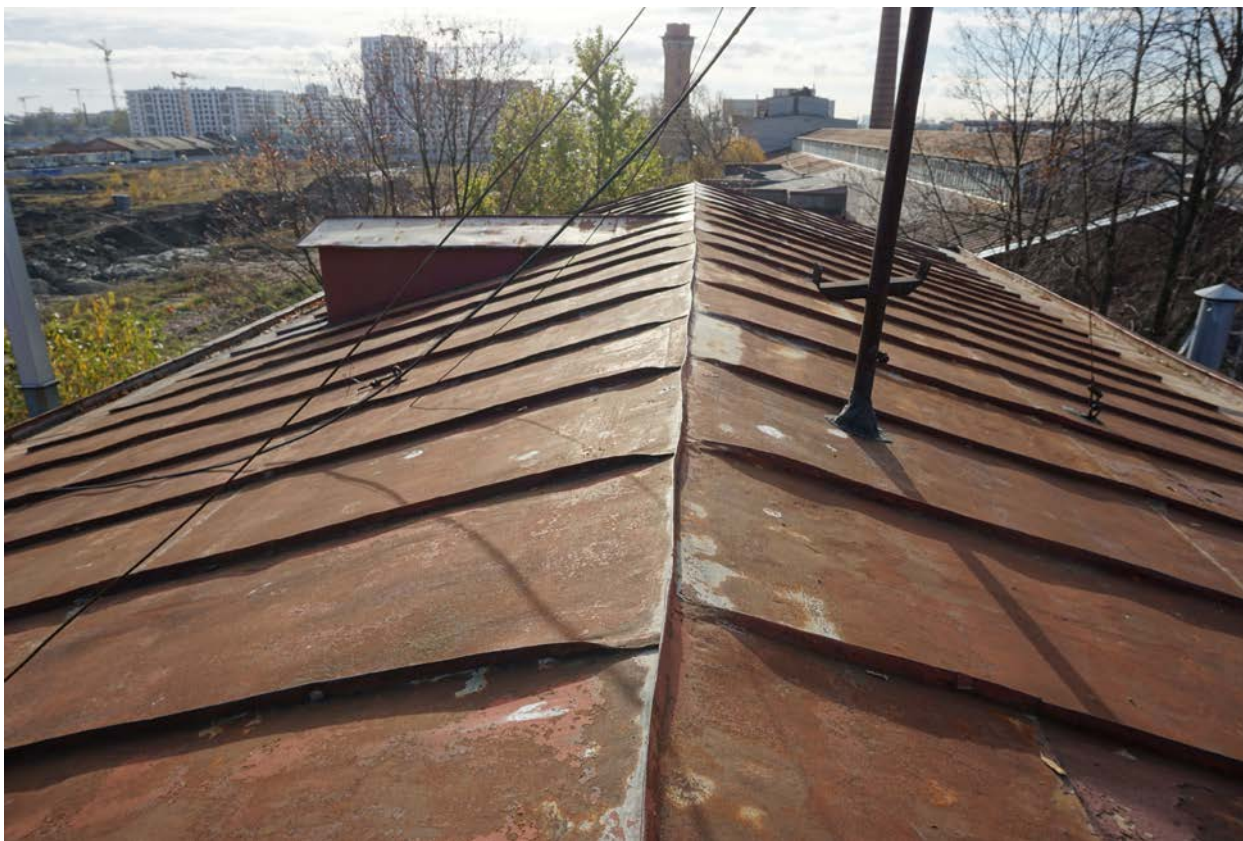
Металлическое покрытие кровли в южной и северной частях здания.
